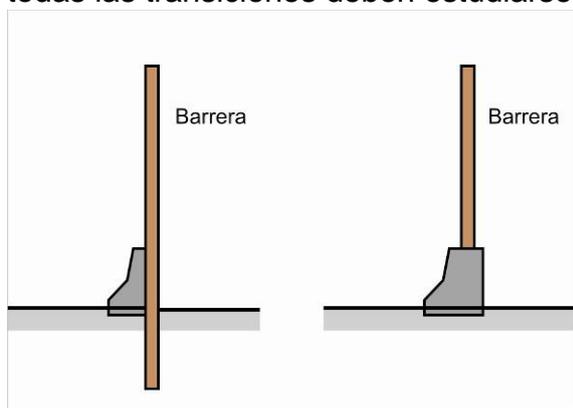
Barrera antirruído de hormigón integrada con barrera de perfil New Jersey
